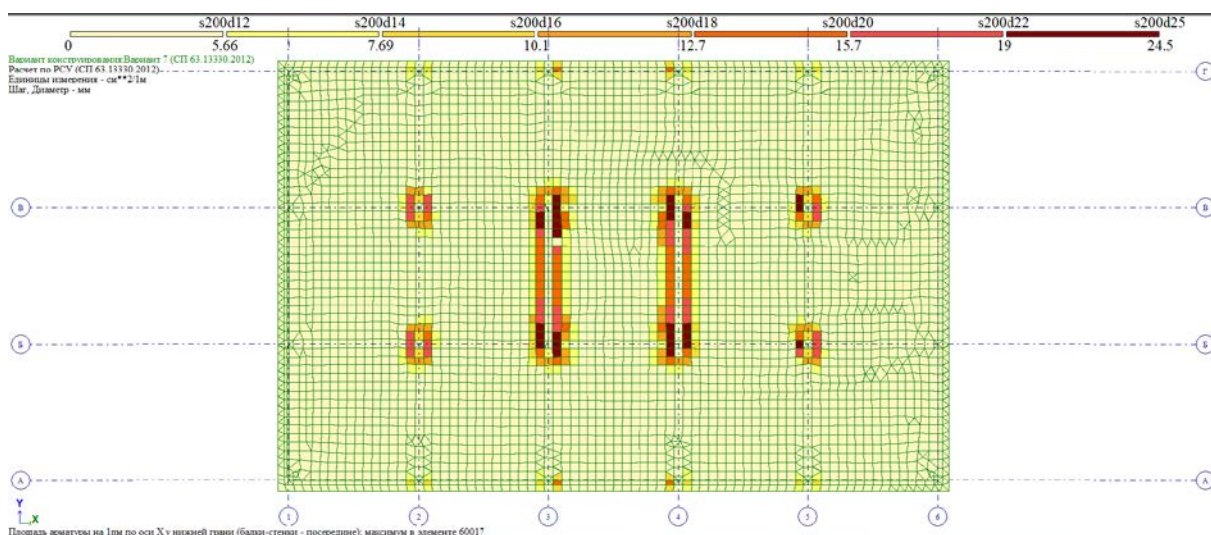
Подобранное нижнее армирование плиты перекрытия по направлению оси X1
